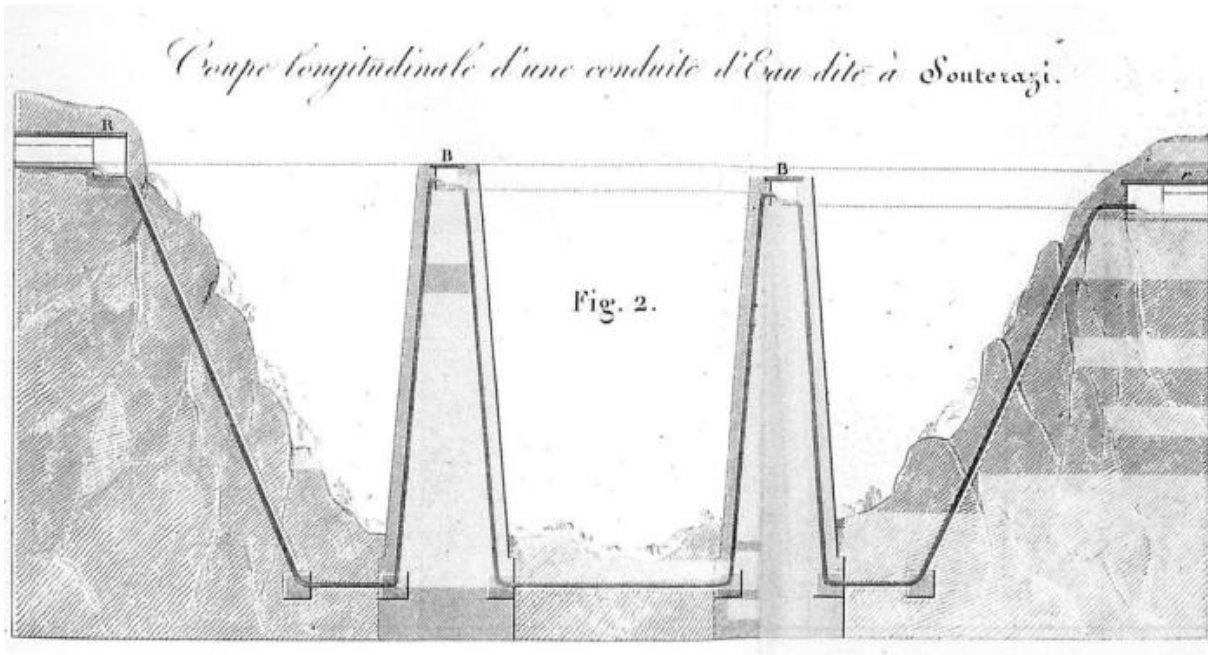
Coupe longitudinale d'une conduite d'eau à souterazi ; représentation par Raymond Génieys dans son ouvrage « Essai sur les moyens de conduire, d'élever et de distribuer les eaux », planche IV. Le dessin explique le fonctionnement du système d'un Souterazi;
